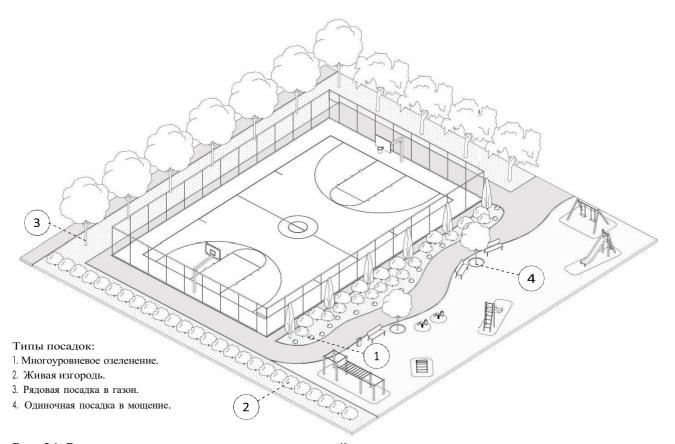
Рекомендуемые типы зеленых насаждений, высаживаемых возле детских и спортивных площадок.
